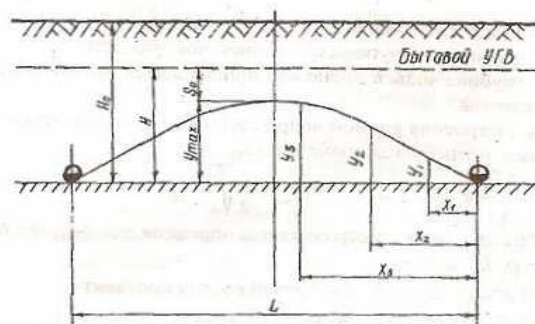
Схема к примеру расчета, совершенного систематического горизонтального дренажа
